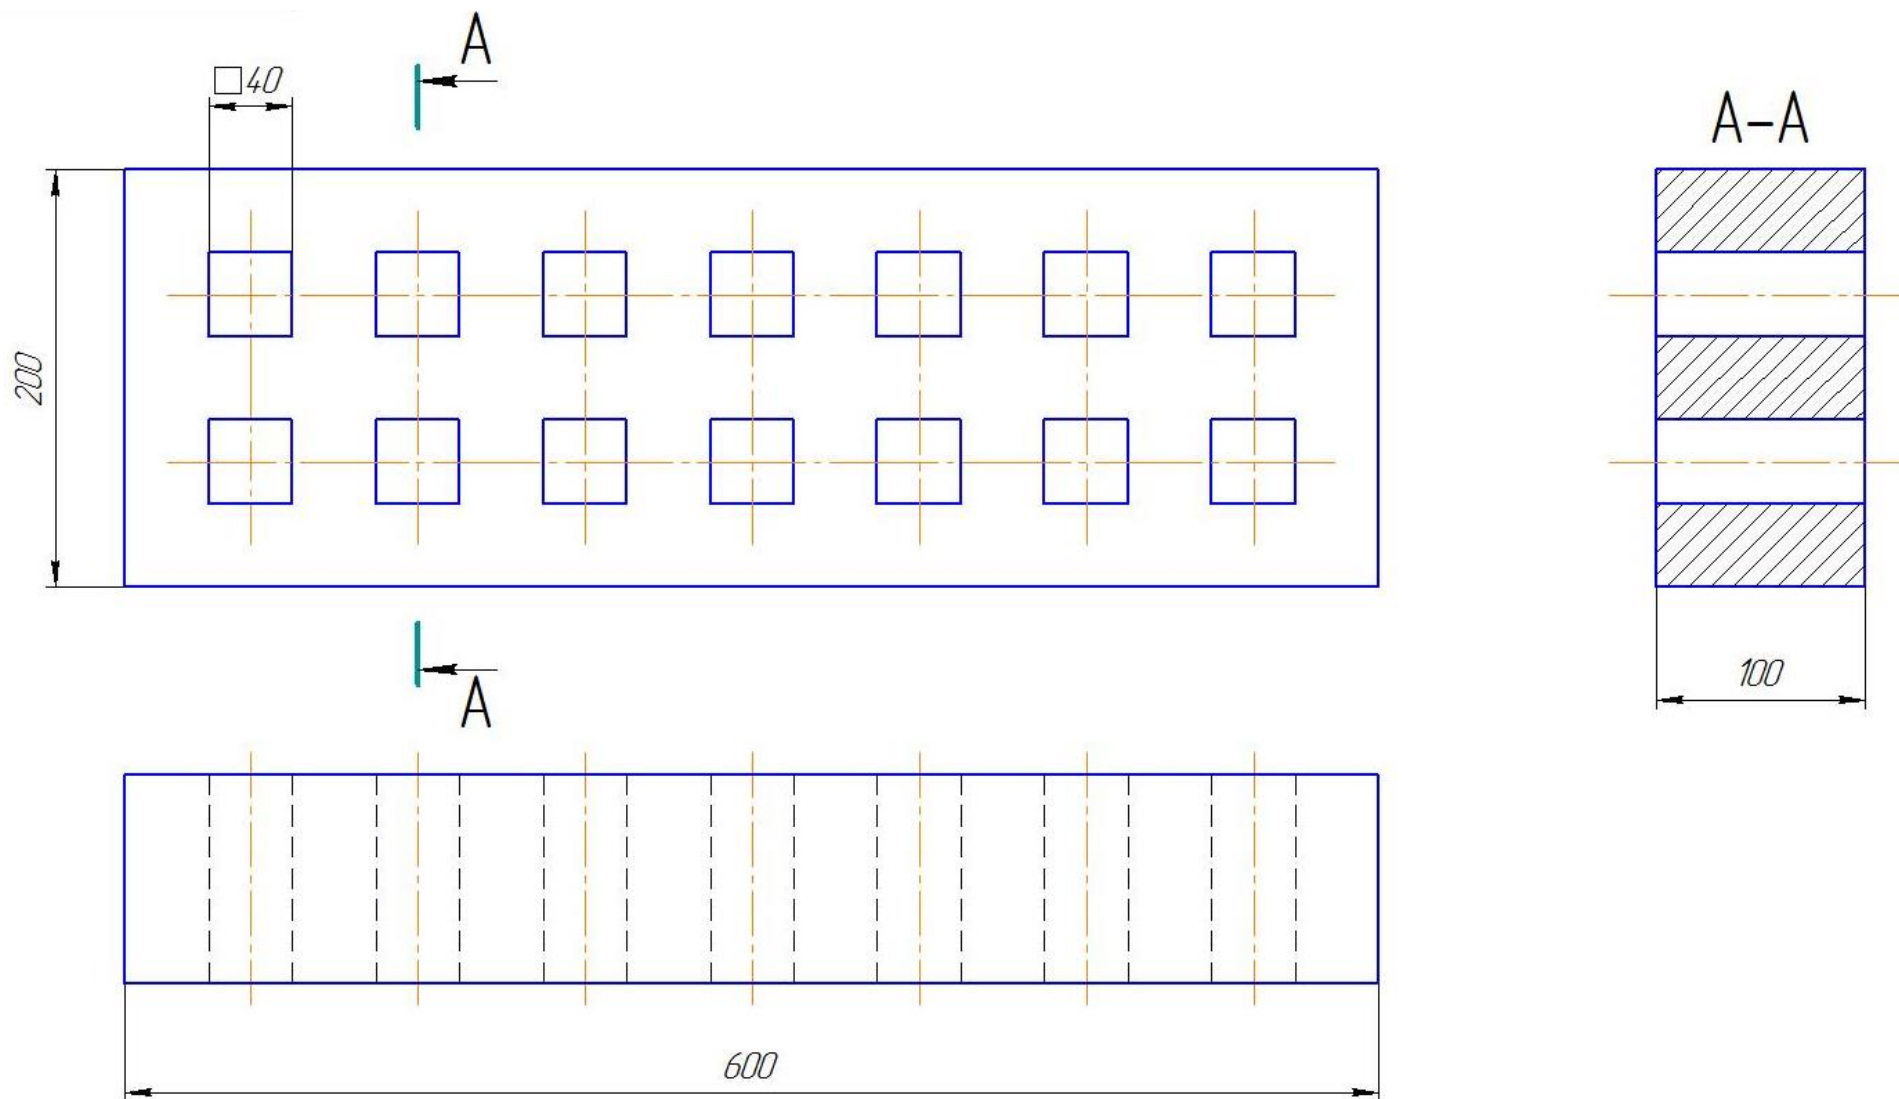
Креслення газобетонного блоку з 14-ма квадратними отворами
